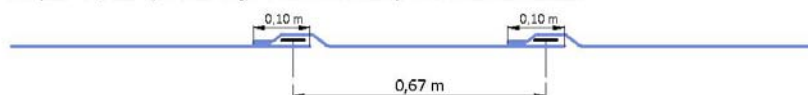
Sikaplan® G / VG en 1,00 m de large. Principe de fixation
